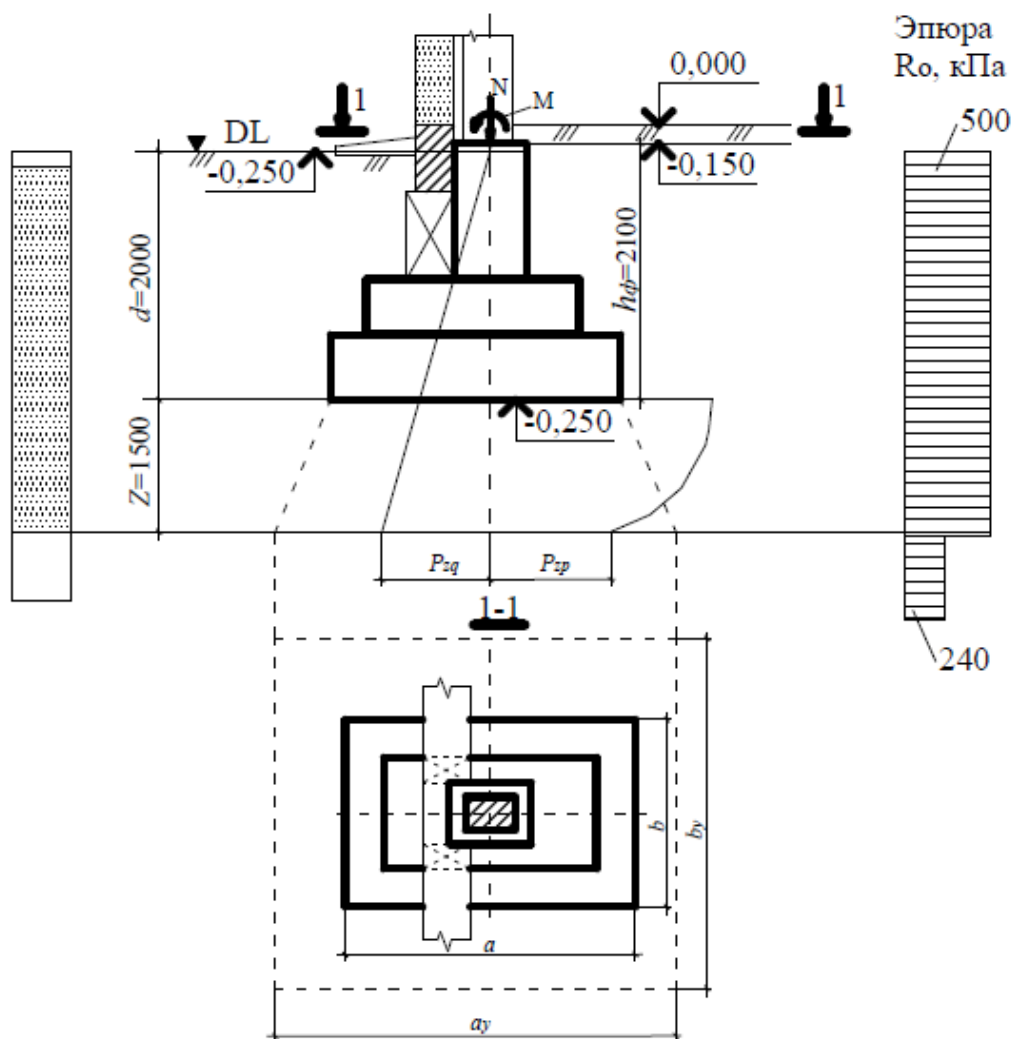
Схема к определению размеров подошвы фундамента с учетом прочности подстилающего слоя (пример 6)
